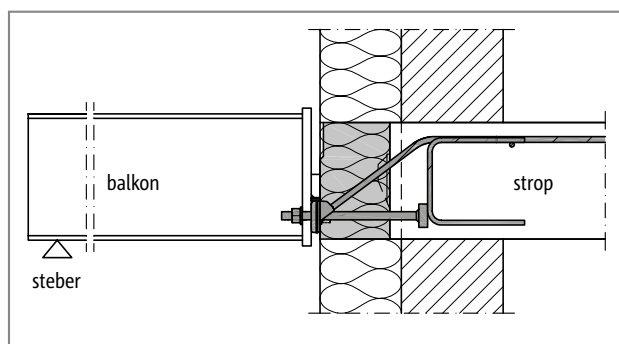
Schöck Isokorb® XT tip SQP: priključek na železobetonski strop; monolitna konstrukcija stene
